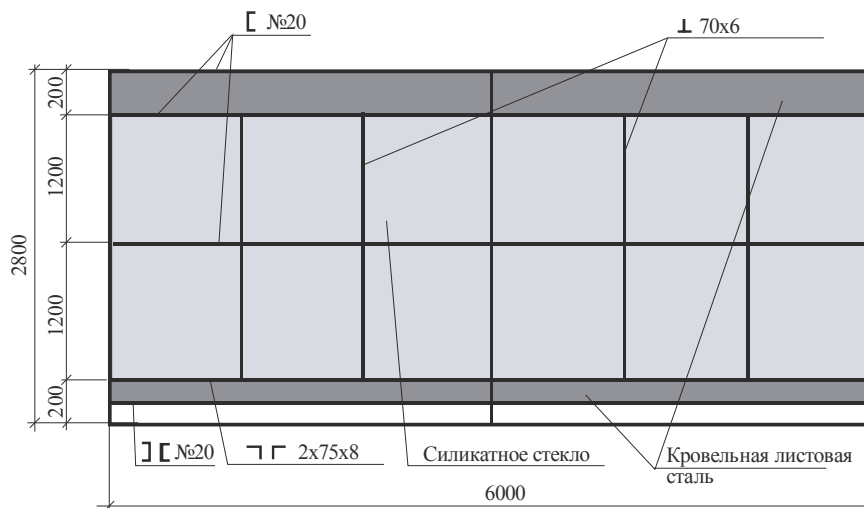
Схема фонарной боковой панели прямоугольного фонаря
